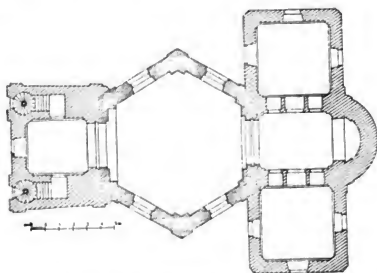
Štáhlau. Grundriss der Sct. Adalbertskirche.
